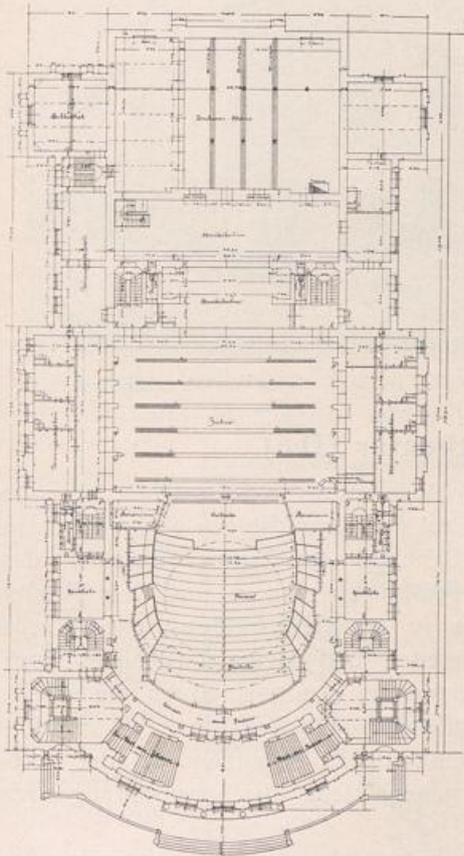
Grundriss des Parterres. 1:740.
